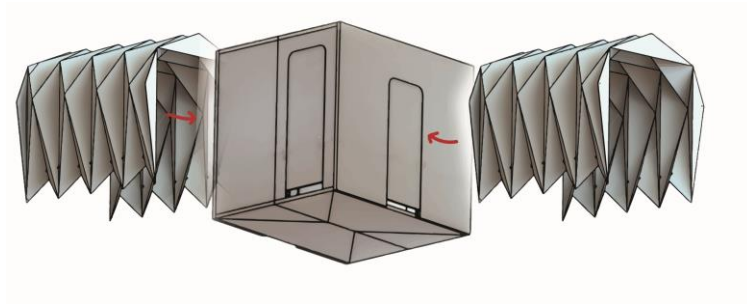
Paso 4. Ensamblaje de las estructuras extensibles con la pieza central
